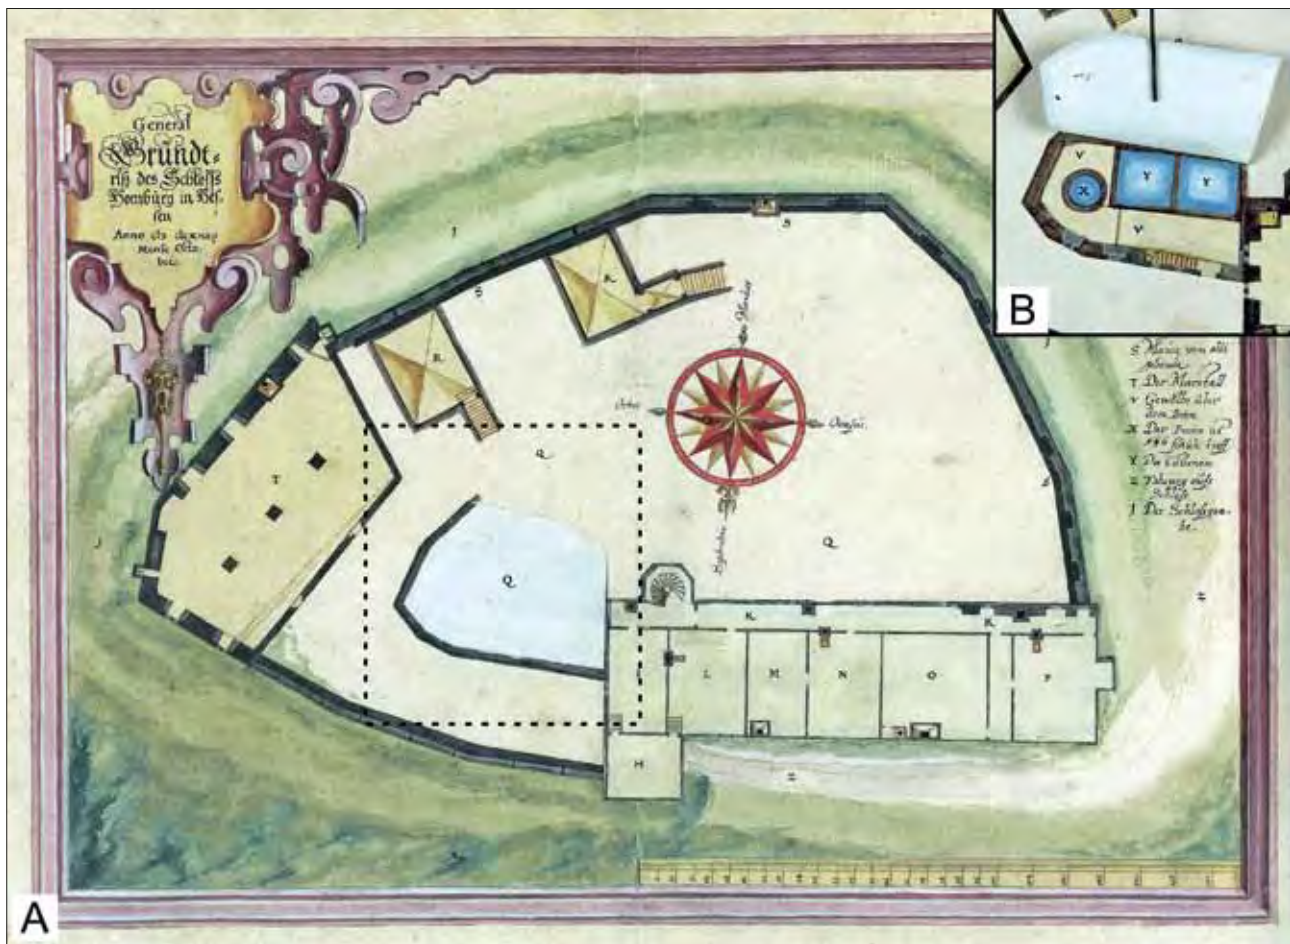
A: W. Dilichs Grundriss der Hohenburg von 1613; B: Ausschnitt desselben Plans vom Brunnenhaus.
